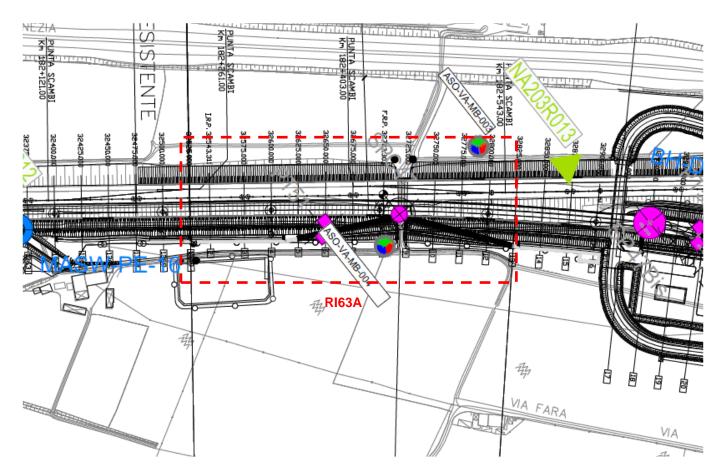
Planimetria Rilevato RI63a, estratto dalla Planimetria Generale (Doc. Rif.[6])
